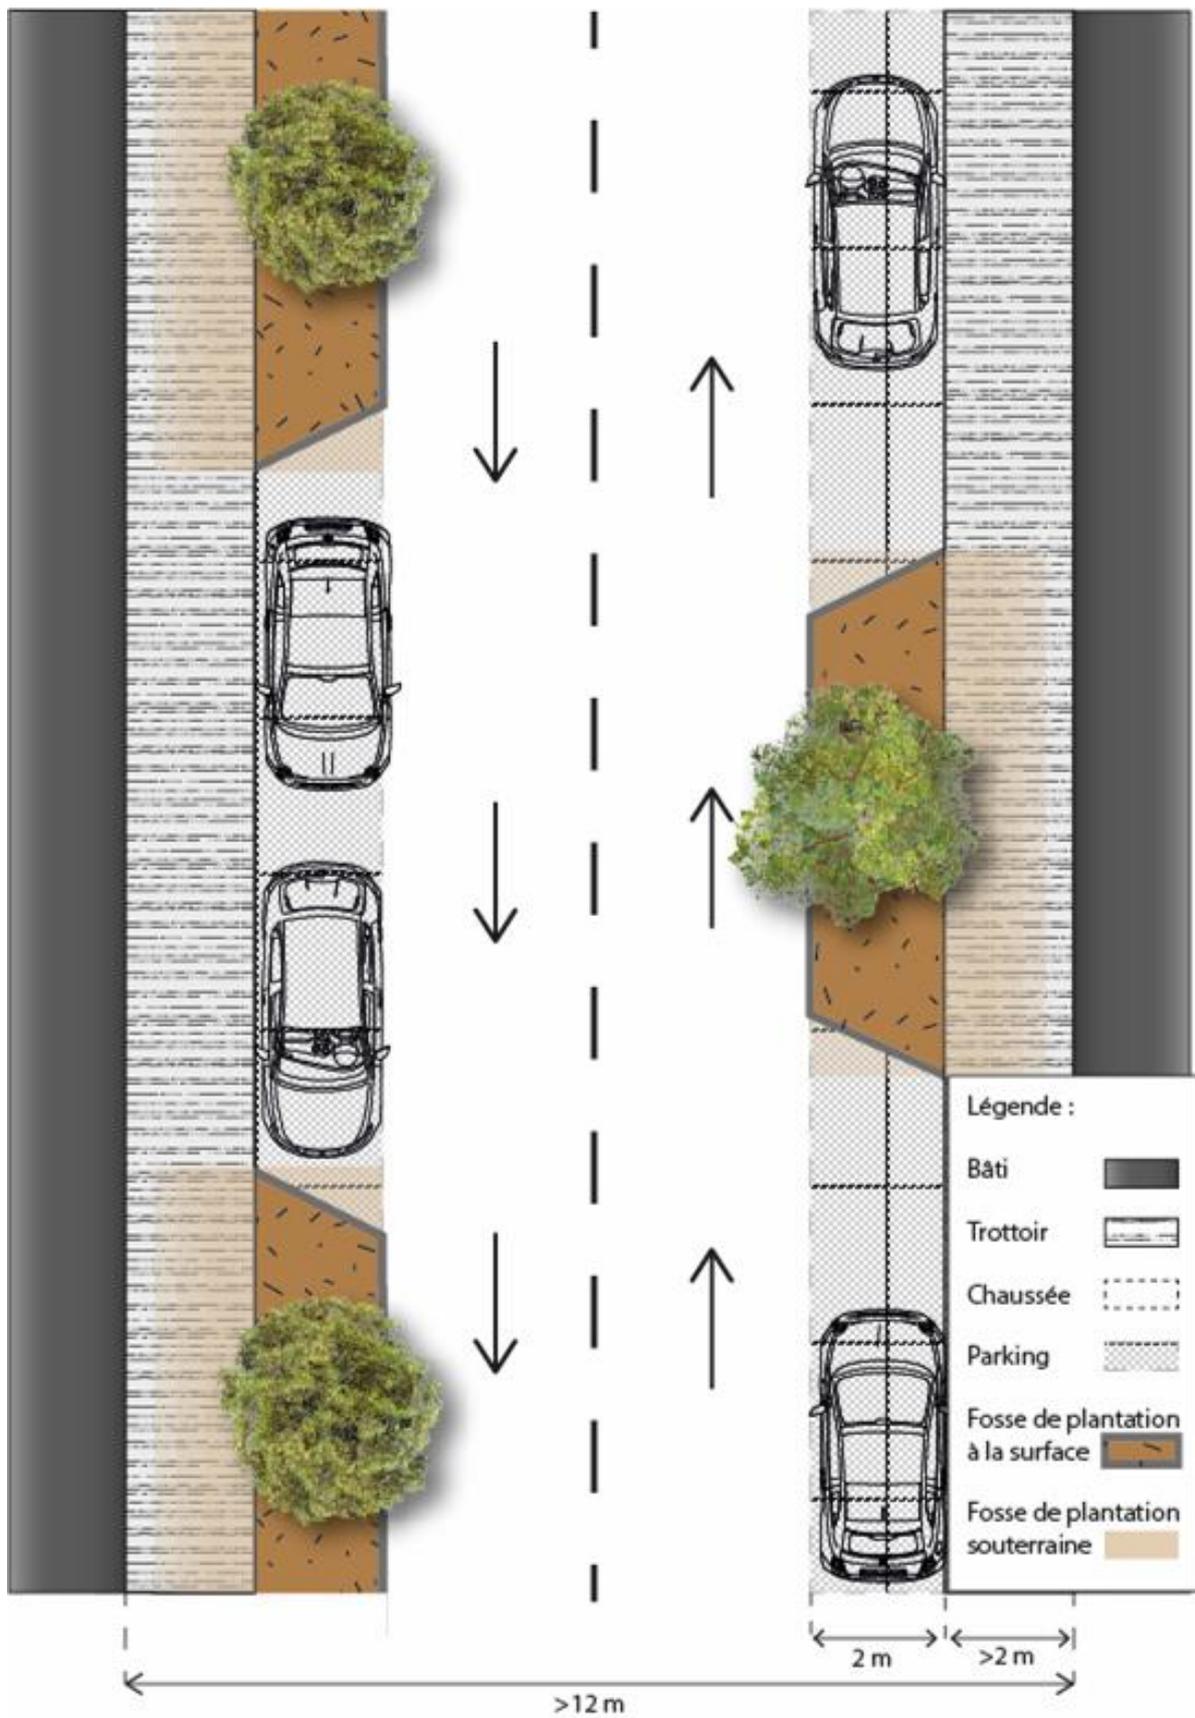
Exemple de plan de voirie double sens avec extension de la fosse de plantation sous le trottoir. (M. Cornut, 2020)
